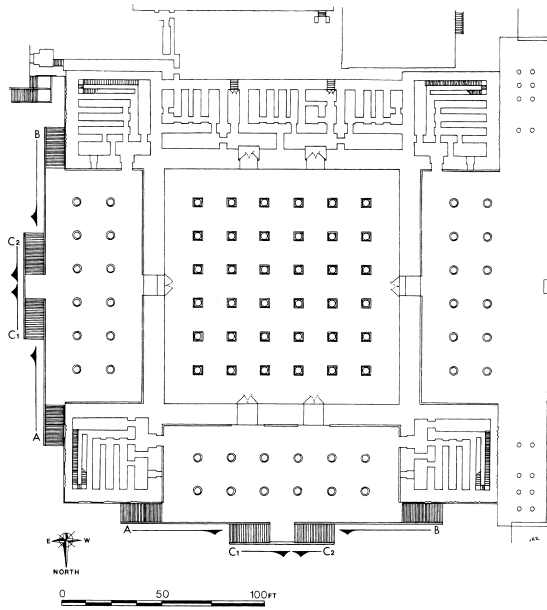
Pasargadae. Paläste. Grundrisse (Gall 1977, Abb. 1.1, 1.2)
